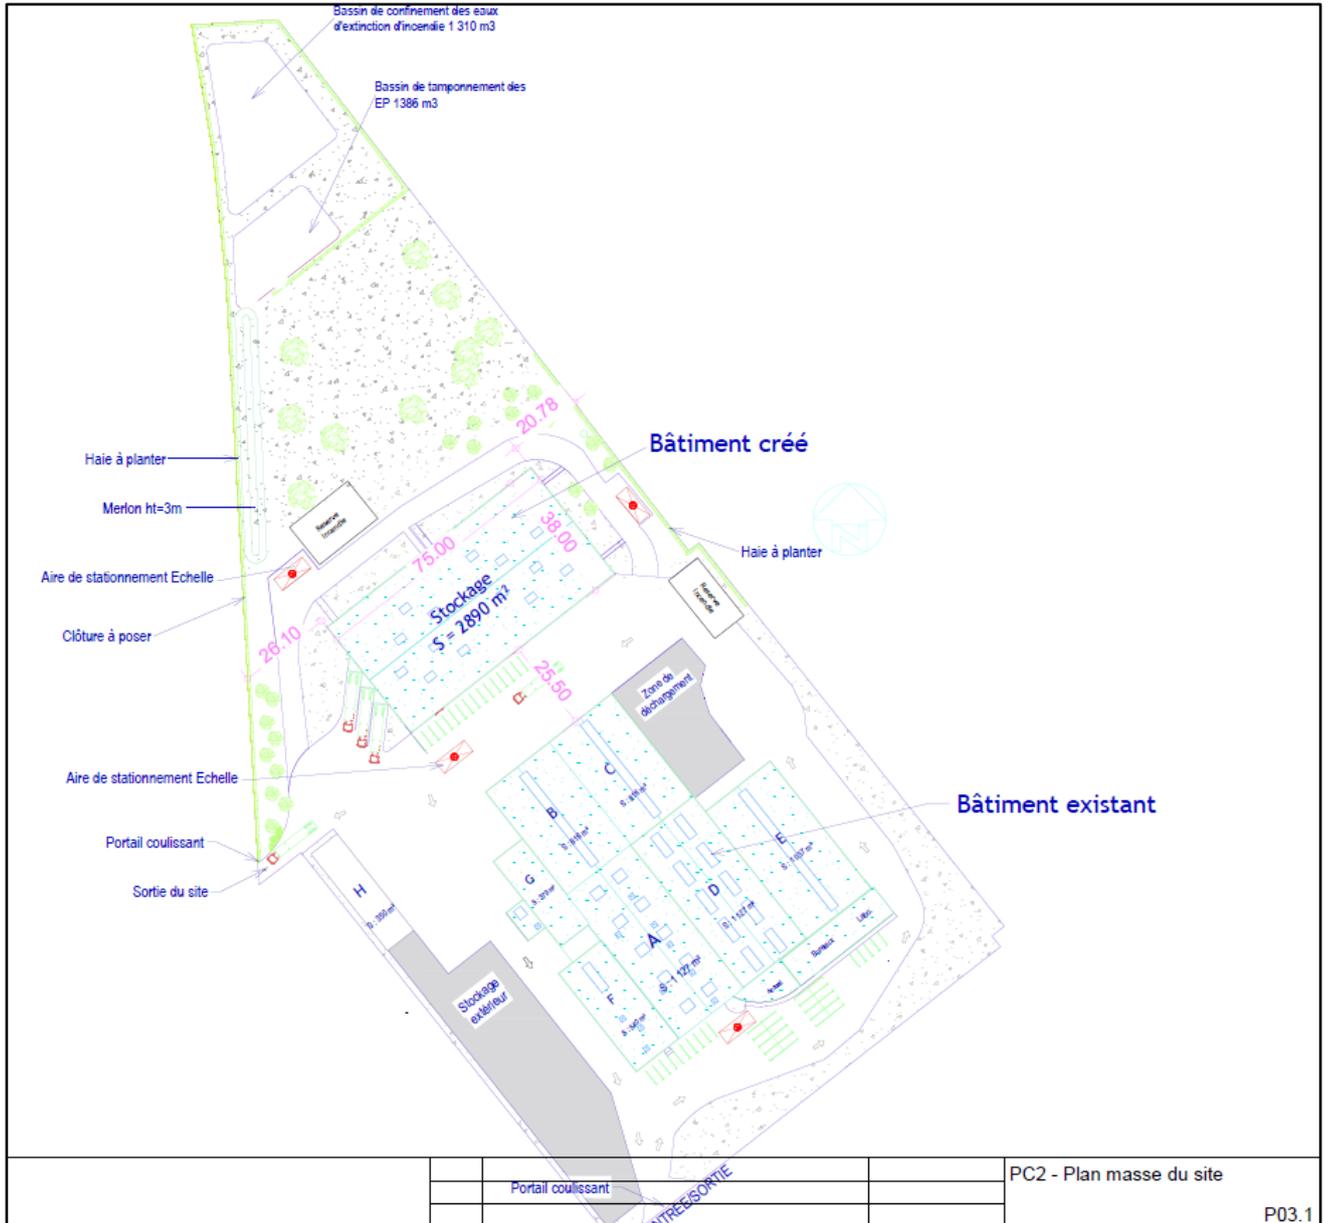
Plan d'ensemble du site (source : sicabconstruction)
